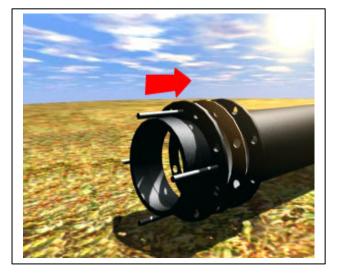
Inicialmente, o equipamento ou tubo flangeado será conectado ao adaptador utilizandose, entre os flanges, um anel de borracha.
